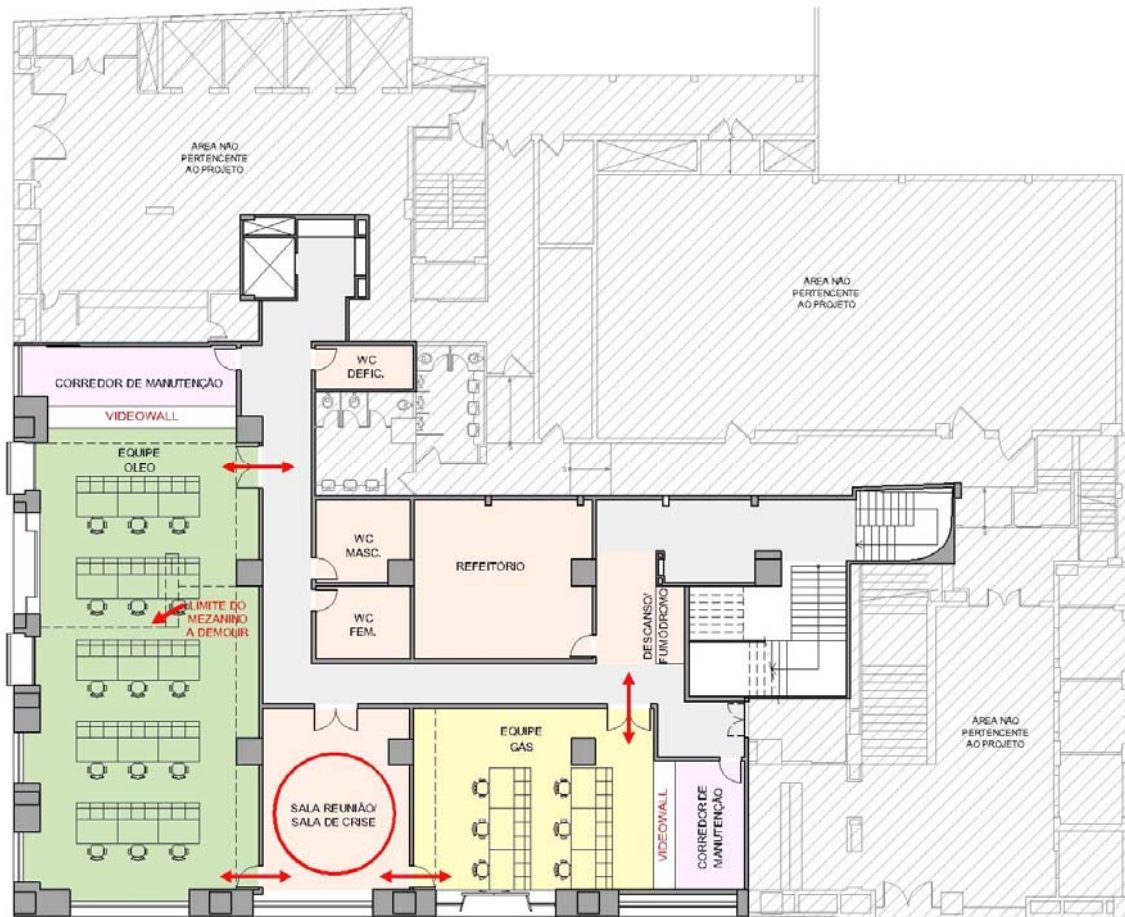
Planta baixa pavimento térreo: opção 4 para o layout (oito de junho)
